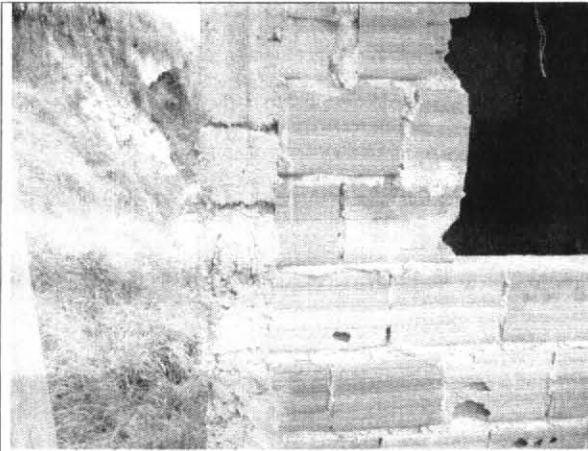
Hormigueros y acero de refuerzo expuesto, reducción de sección transversal del elemento.
